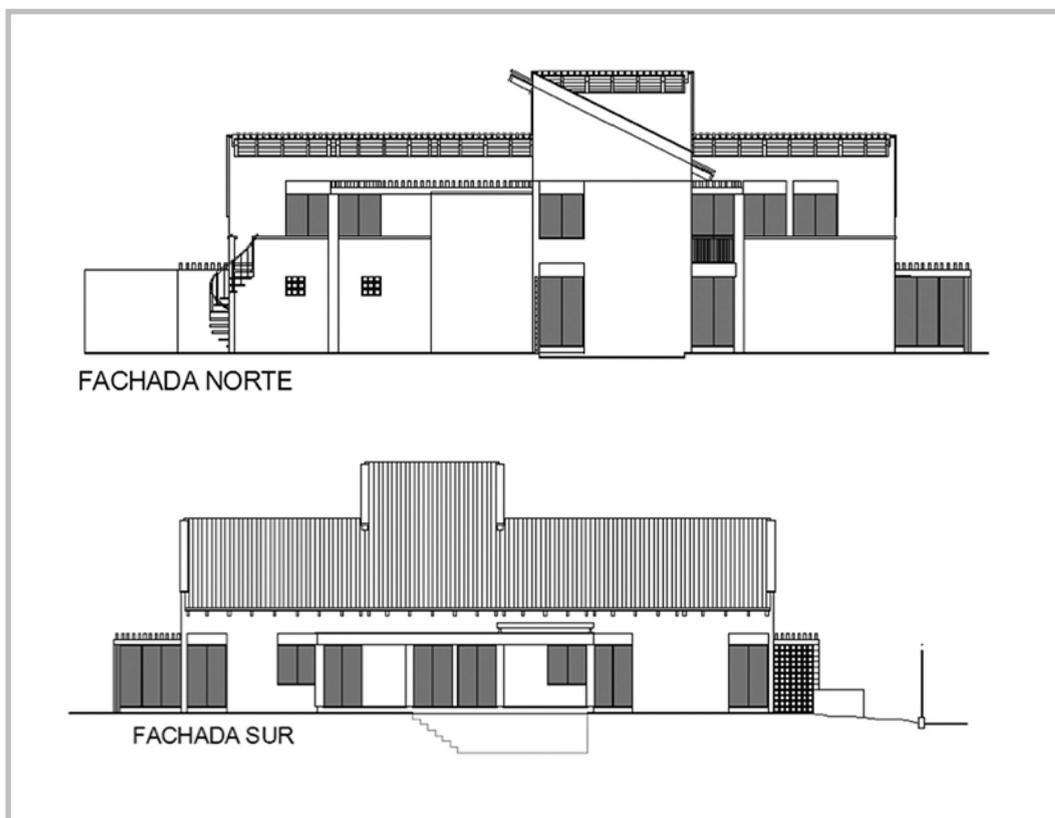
Fachadas “Casa del Agua”. Fuente: Planos Benjamín Barney (2010)
